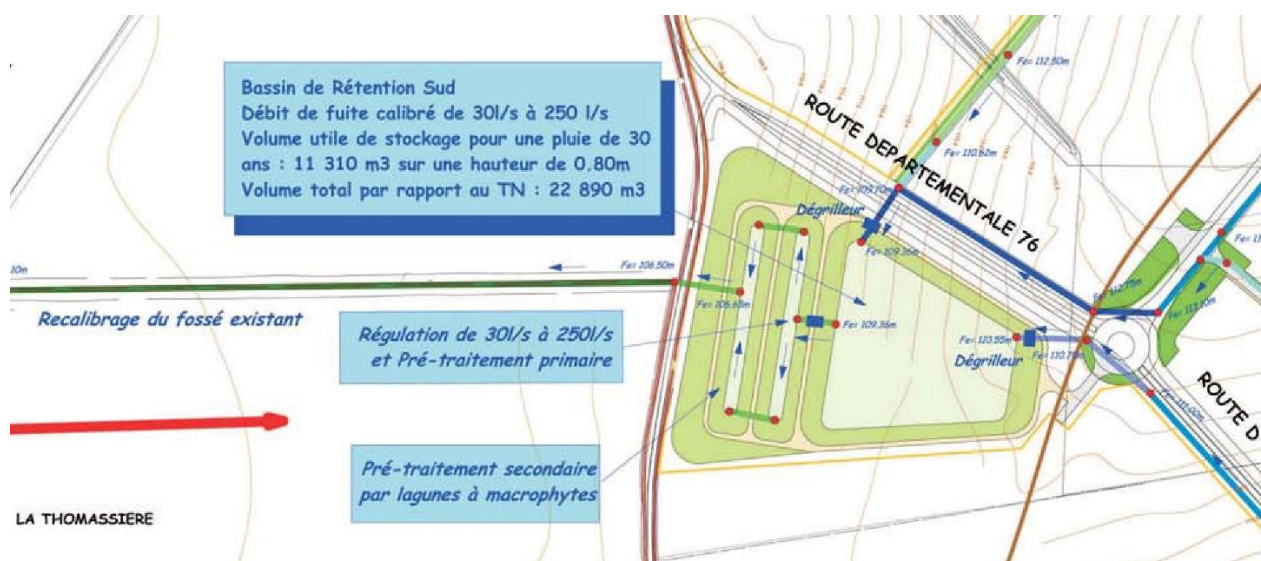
Extrait du plan du bassin de rétention n°1 (Sud)
